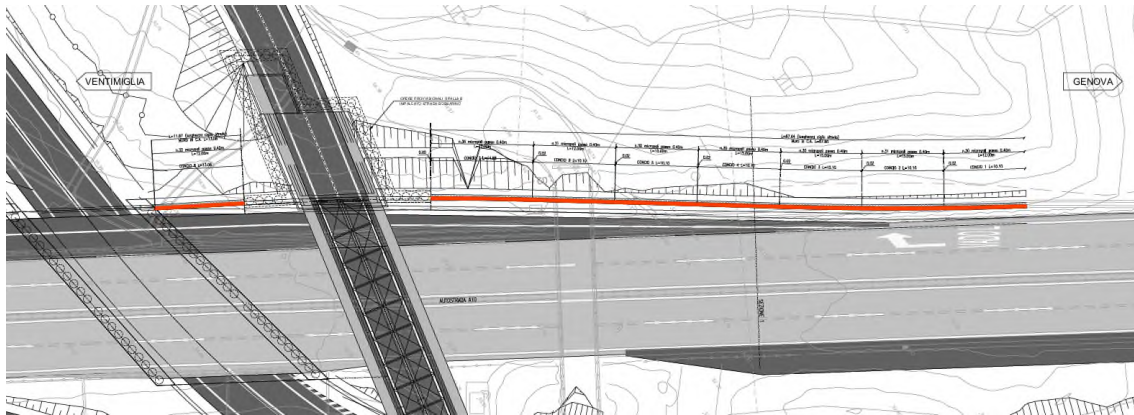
Planimetria ramo Genova – Casello_da svincolo a ponte Bossarino 1
